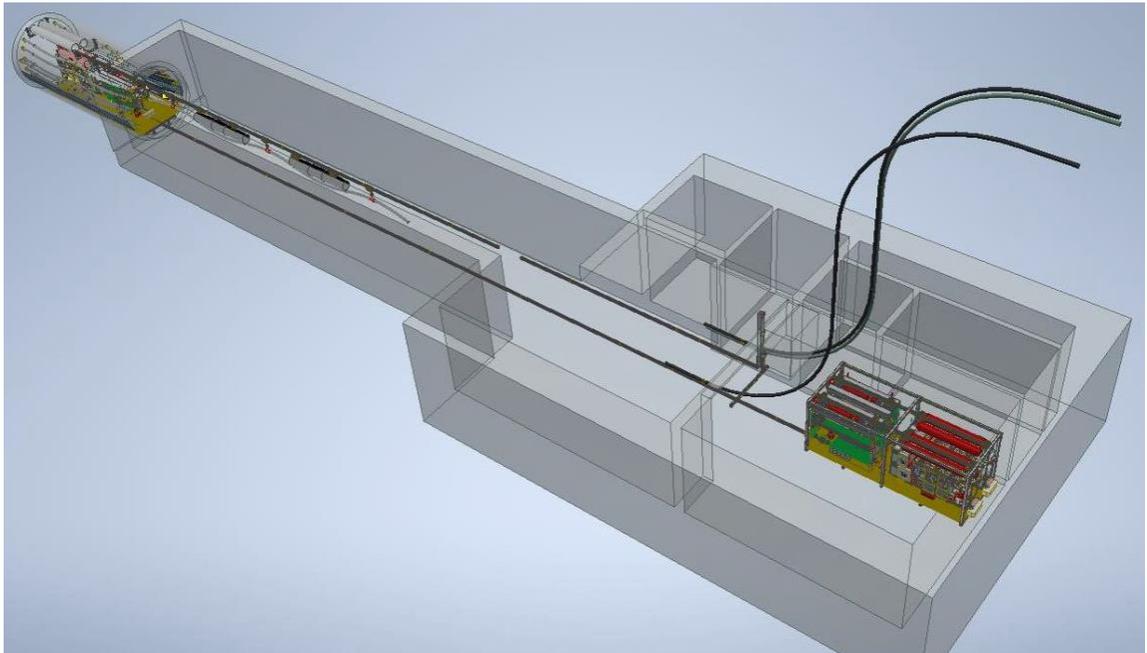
3D-Modell der Kabelführung aus dem Muffenbauwerk über das Schachtbauwerk hinein in den Tunnel mit einer vorläufigen Variante der Verschiebeplattform mit Tunnelfahrzeug. (NOWILAN GmbH 2020)
